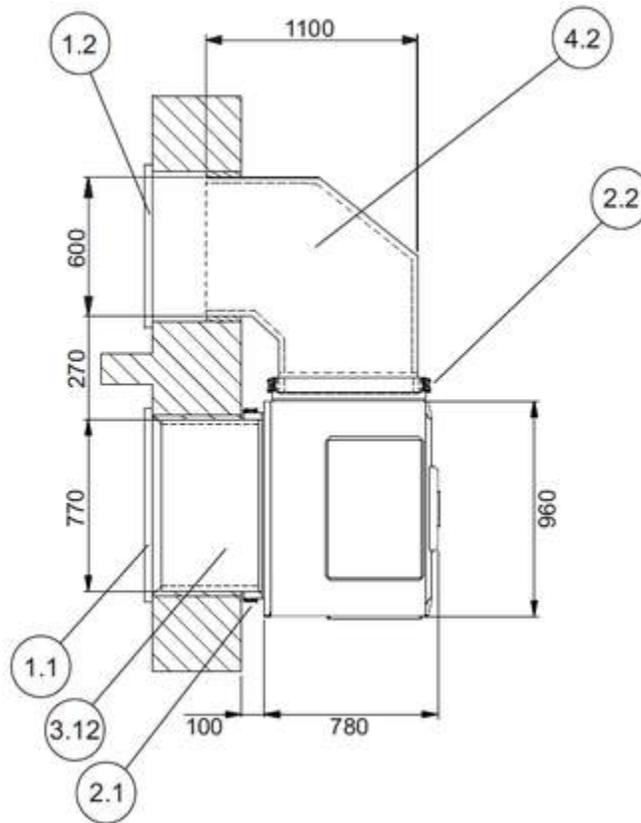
Vista dall'alto - LIK 12TU (Installazione a parete con canale aria lato mandata)
